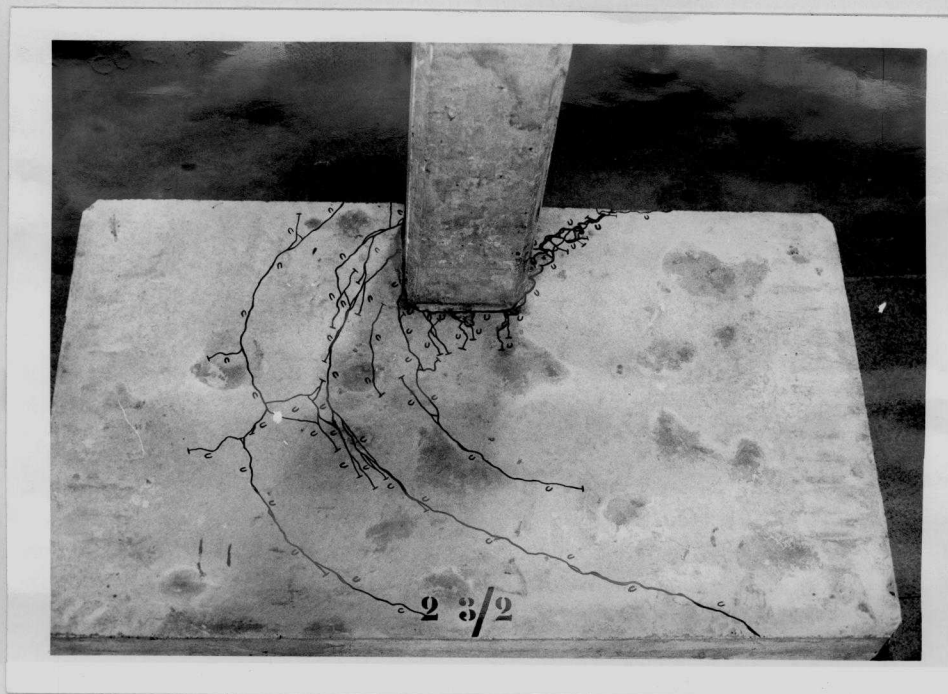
c - Fissuração na face inferior do modelo EdL 23/2.
